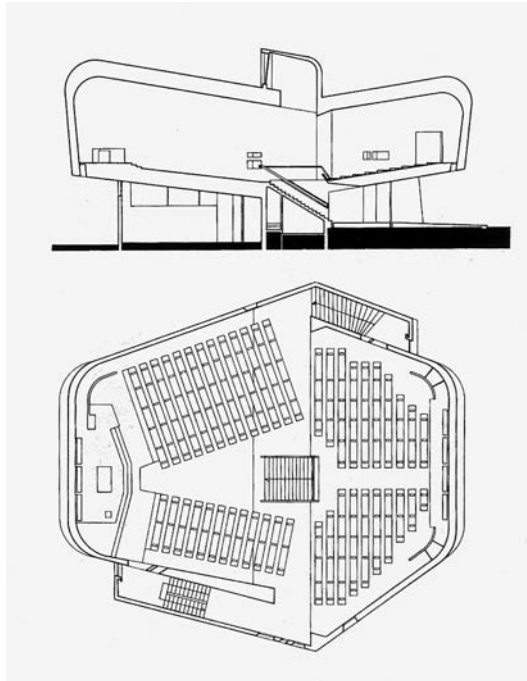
Claude Parent und Paul Virilio/Architecture Principe, Église Sainte-Bernadette du Banlay, Nevers, Frankreich, 1963–66. Längsschnitt, 79 x 96 cm, und Grundriss des ersten Obergeschosses, 79 x 99,5 cm, Tinte auf Transparentpapier.
